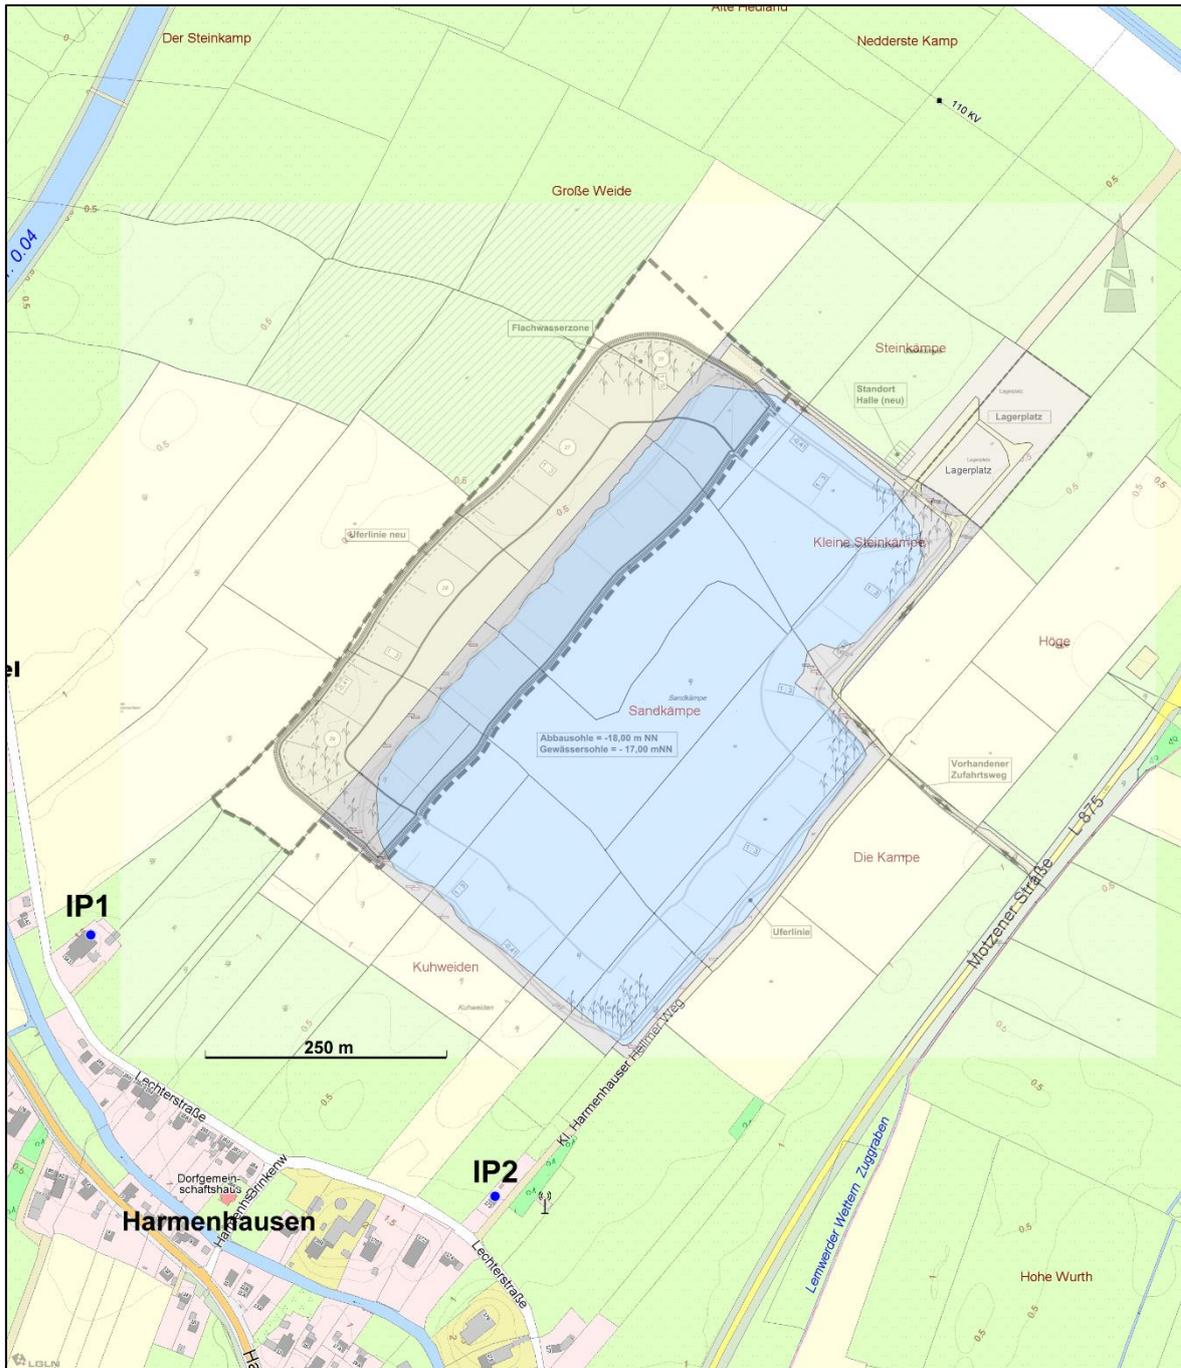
Lageplan (© LGLN) von der Abbaustätte mit Umgebung inklusive Einblendung der geplanten Erweiterungsfläche
